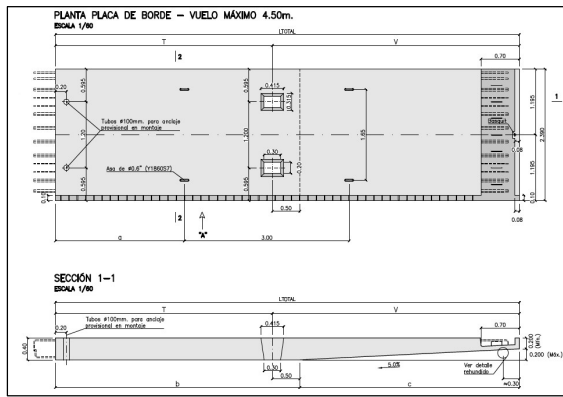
Planta y sección transversal de placa prefabricada para voladizo.
